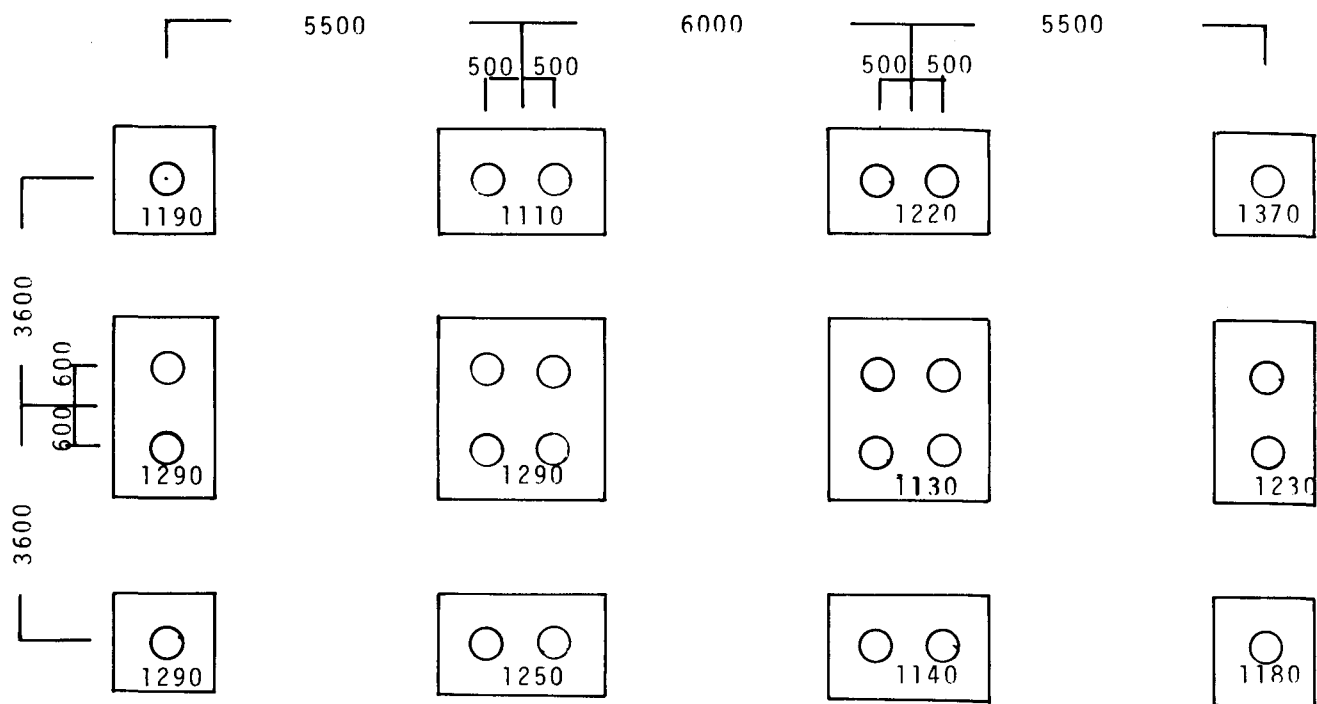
夏期隊員宿舎ビア部分平面図(単位mm)
